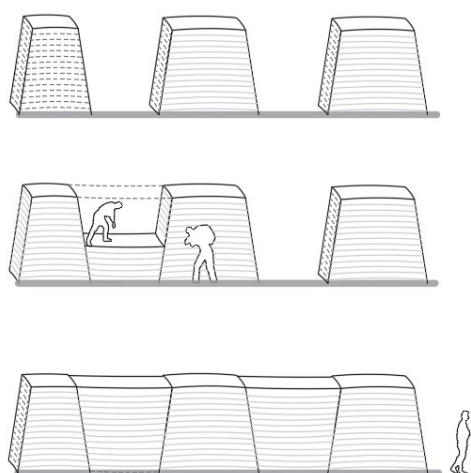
Secuencia de posibilidades en la construcción de los muros segmentados. A: Bloques construidos simultáneamente. B, C y D: Construcción alternada.
